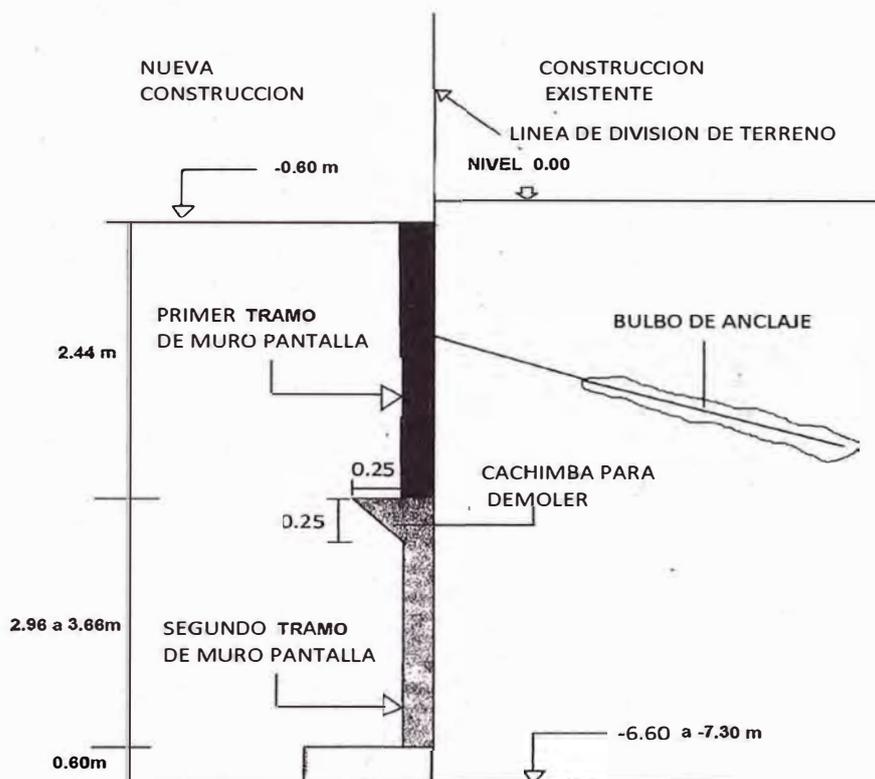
Sección transversal del muro pantalla construido en dos tramos.
